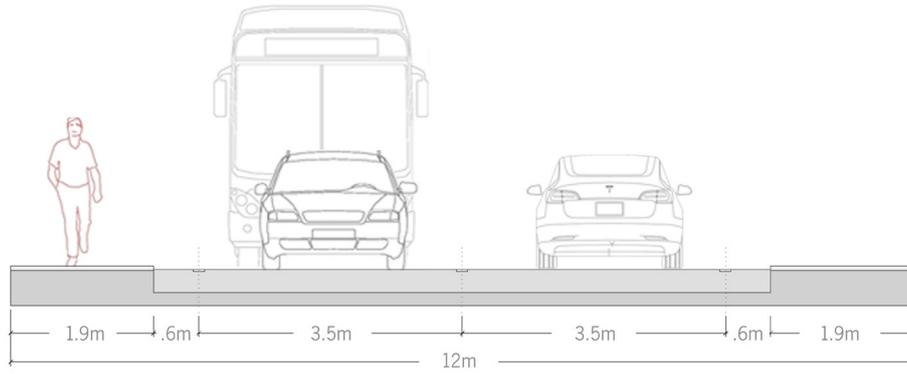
Perfil atual geral da avenida do Cávado de 12 metros
